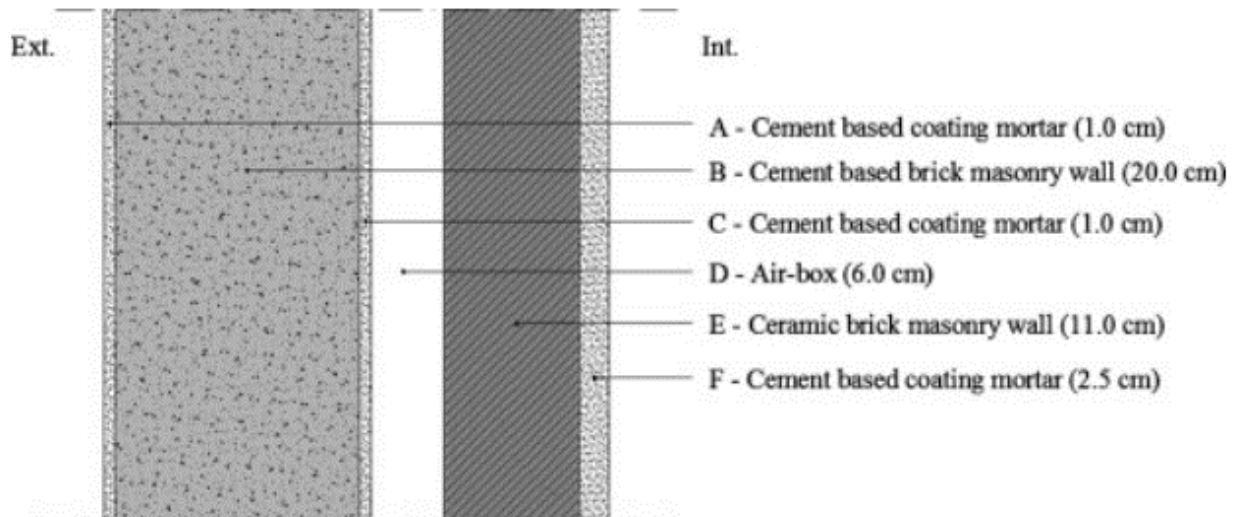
Detalle constructivo del muro creado para el estudio experimental. Fuente:
